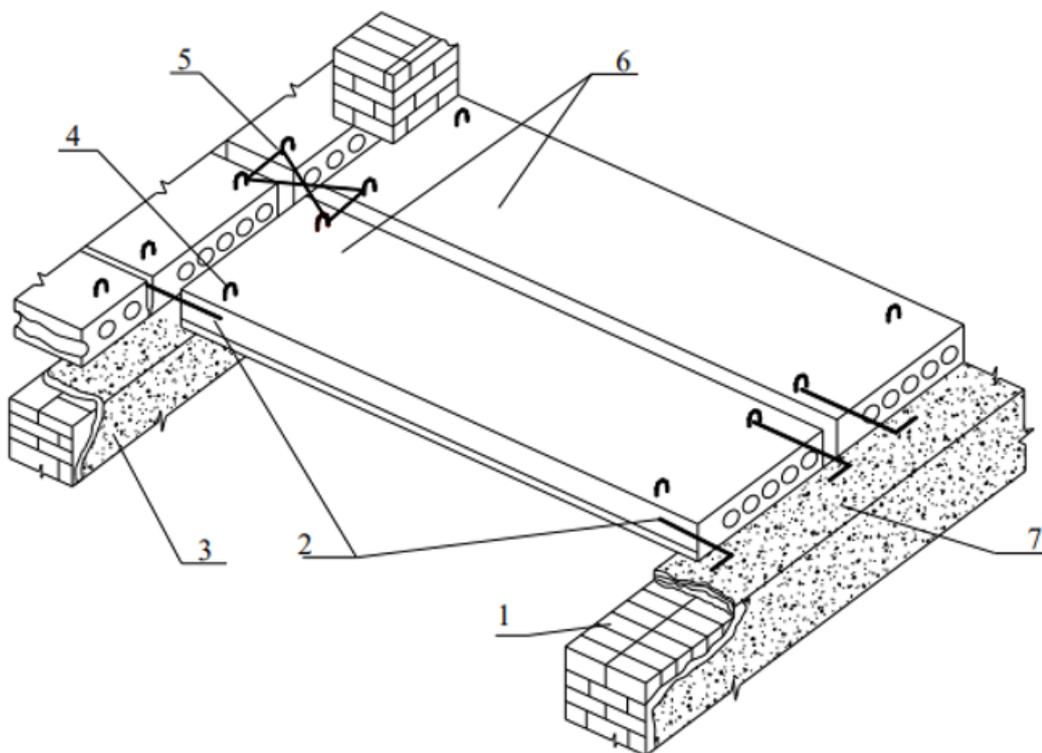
Міжповерхове перекриття по залізобетонних панелях:
